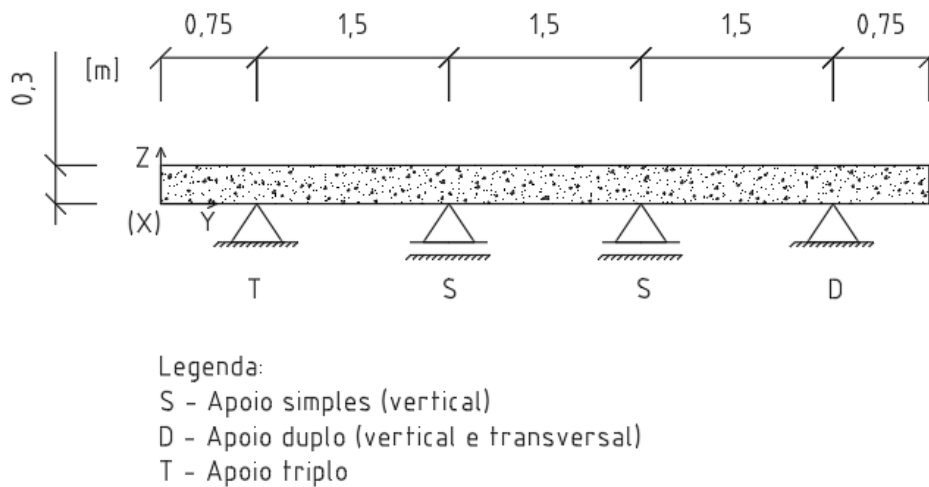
Corte A-A da laje e representação das condições de apoio (no modelo com elementos planos; os apoios, tal como a carga pontual, referem-se ao plano médio da laje)
